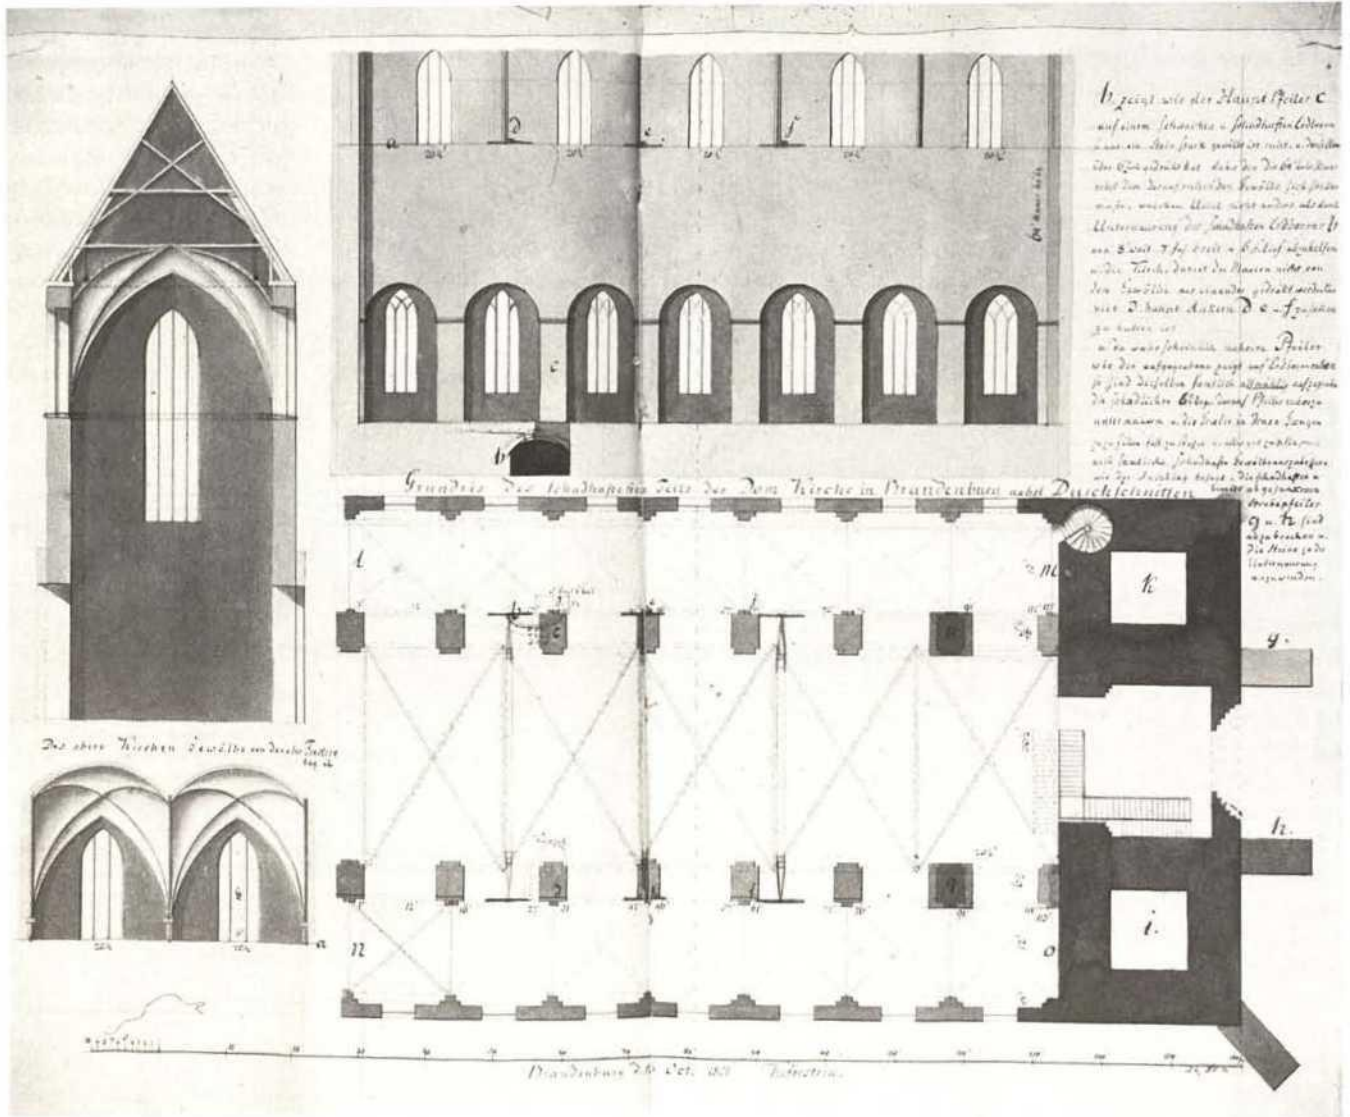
Dom zu Brandenburg, Längsschnitt mit Blick nach Süden, mit Eintragung eines damals ergrabenen eingedrückten Fundamentbogens, Querschnitt und Grundriß gemäß Keferstein, 1801
